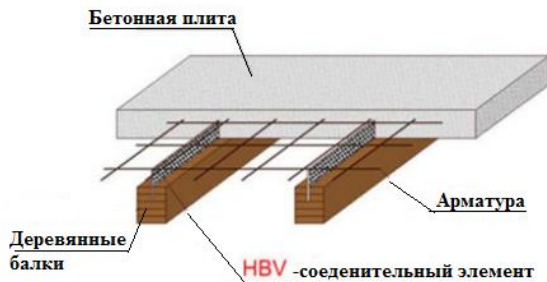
Устройство деревожелезобетонного перекрытия HBV-технологии / The device wood reinforced concrete slab HBV technology
